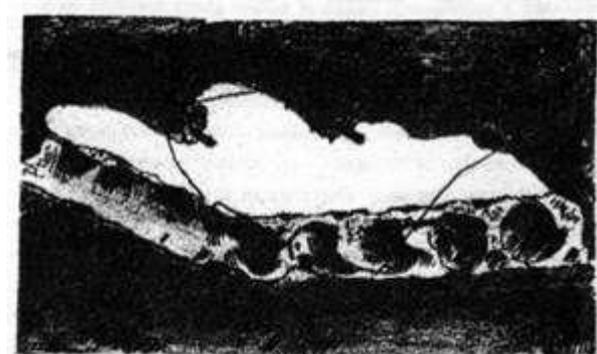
Отверстие, пробитое в пустотной плите перекрытия для пропуска коммуникаций. Из семи ребер перебито пять.
